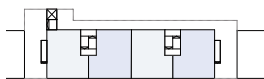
Grundrisse Altbestand und Ergebnis EG Dachau, Birkenrieder Straße 2–4
